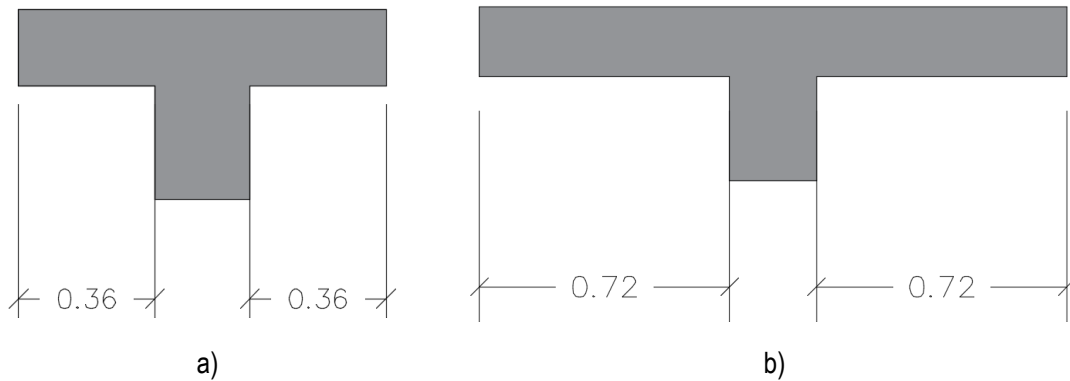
Larguras efetivas do banzo; a) Ligação a pilares exteriores; b) Ligação a pilares interiores.
